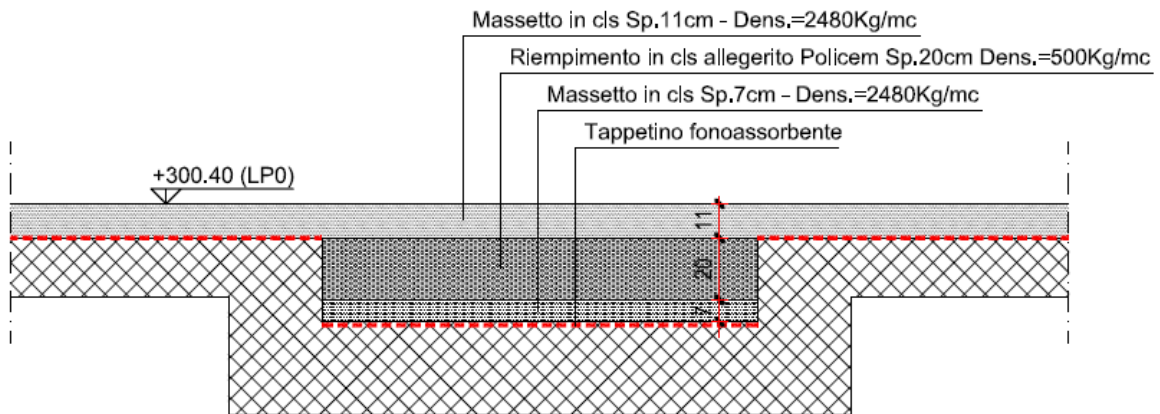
dettaglio realizzazione pavimentazione nel reparto di radiologia
